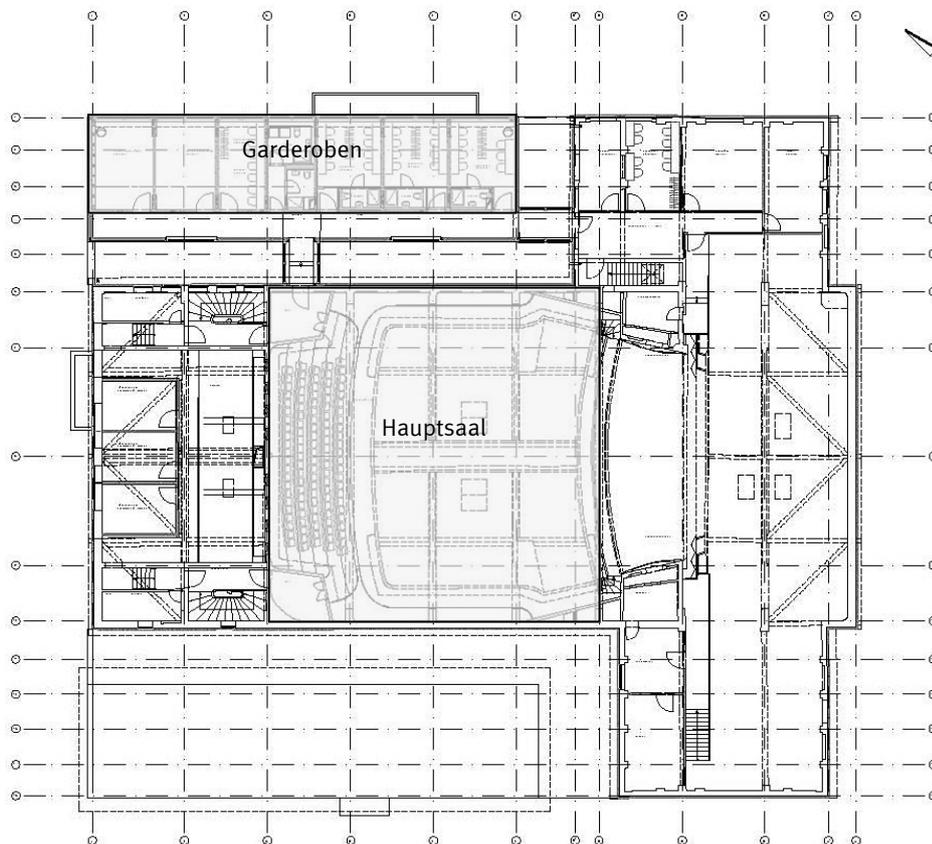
Grundriss Obergeschoss mit markierten exemplarischen Messräumen, ohne Maßstab
